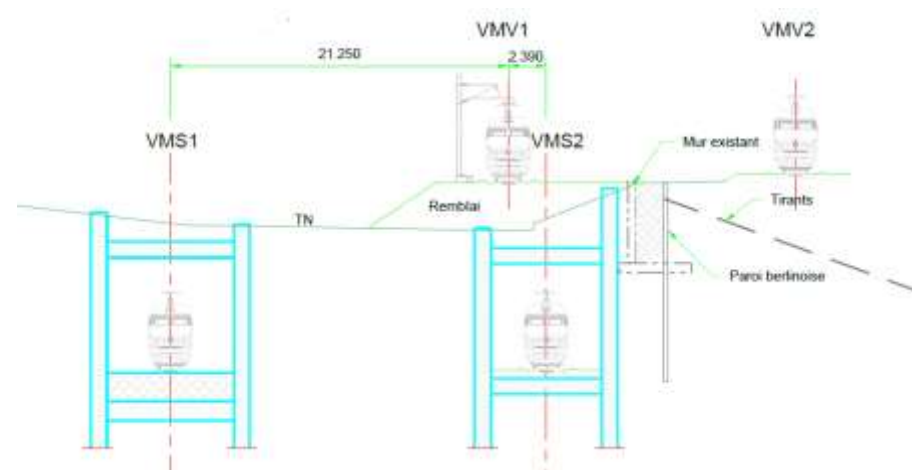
Profil en travers – tranchée couverte (EGIS, 2021)
